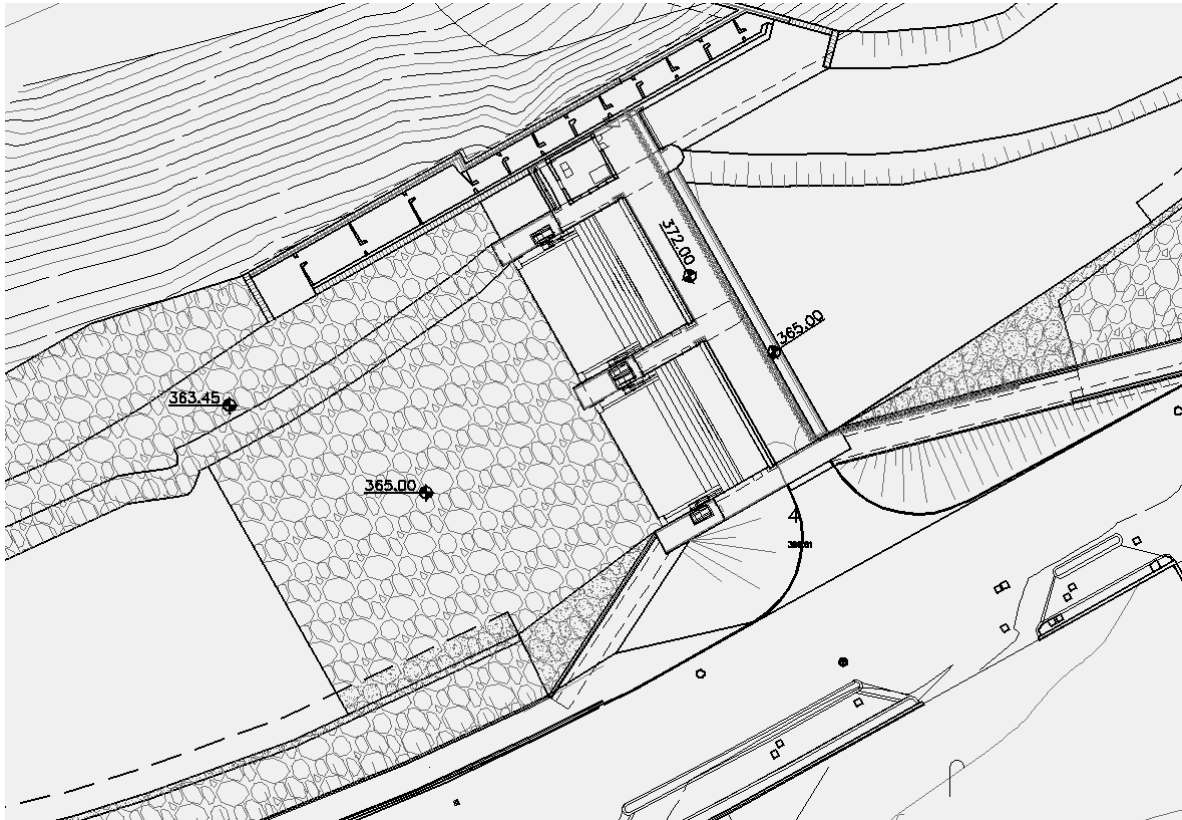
Estratto della planimetria di progetto della traversa con la protezione al fondo previsto a valle dell' opera.
